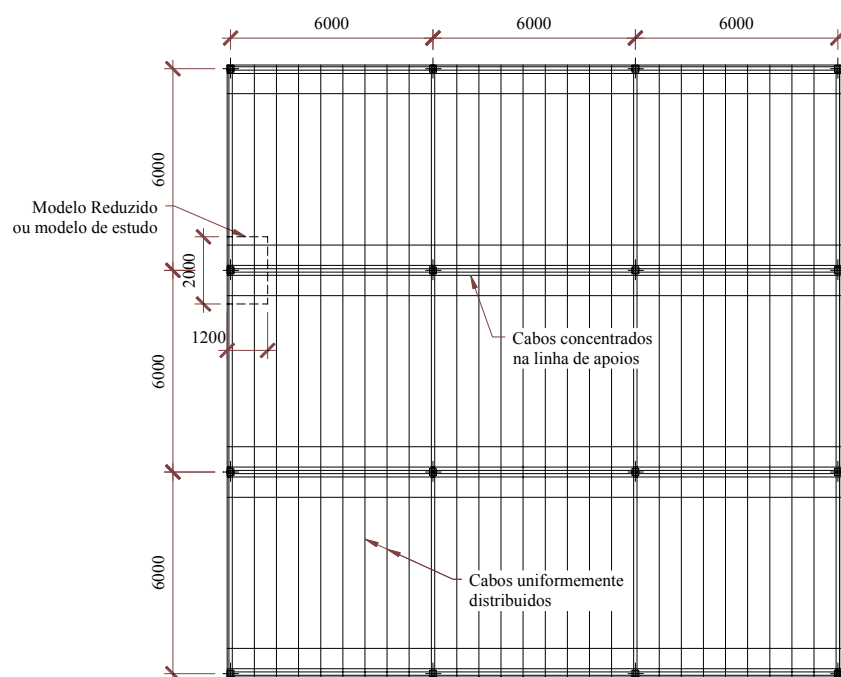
Arranjo dos cabos no pavimento completo de laje protendida.
